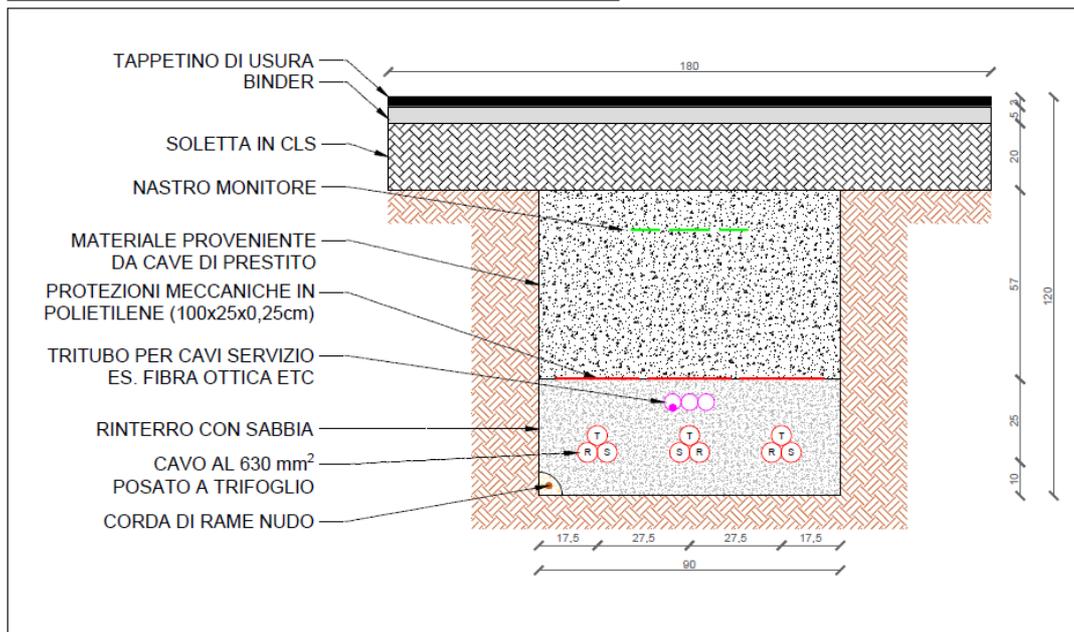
Sezione tipo di posa cavidotto MT su Strade Statali (attraversamento)
